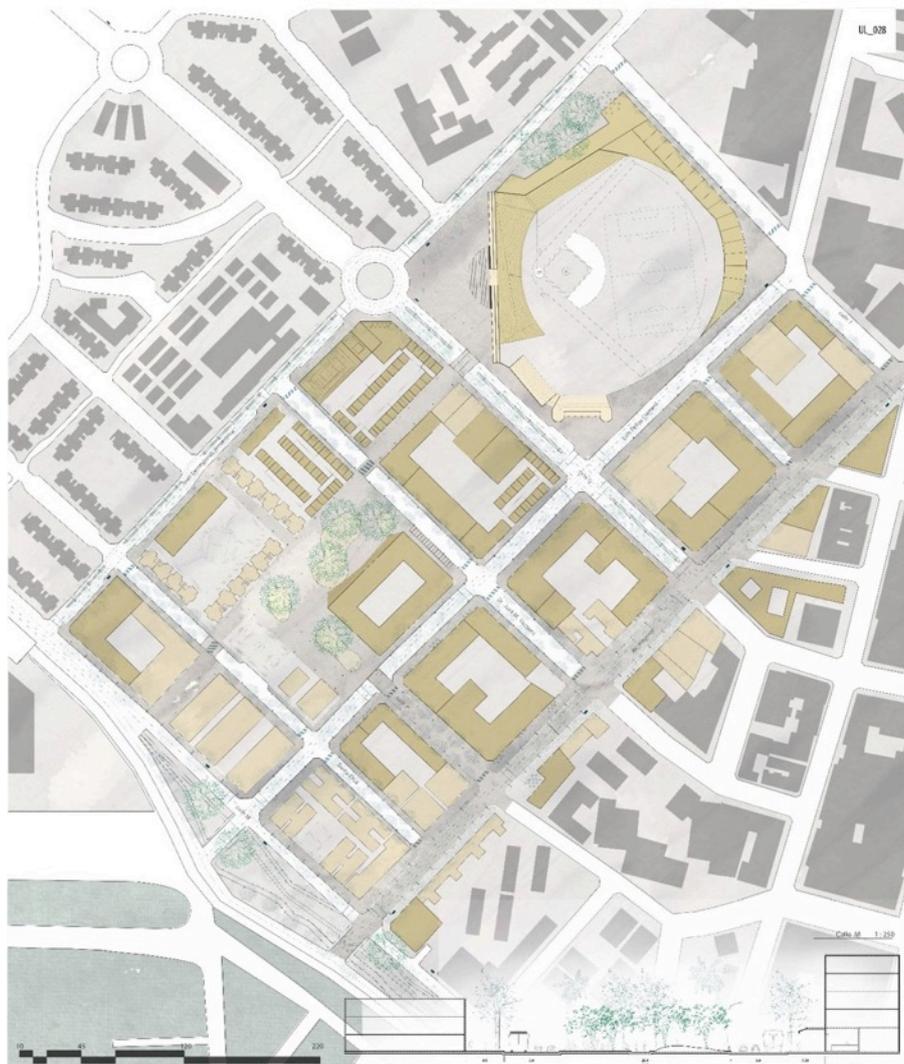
Planta General propuesta para "Curundú: Barrio Vivo"
